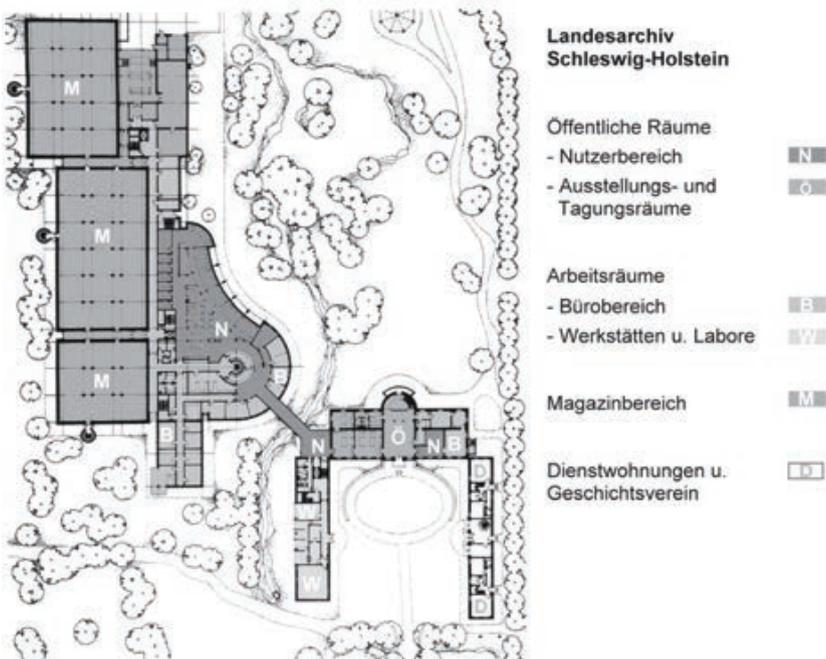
Grundriss mit markierter Raumnutzung.
